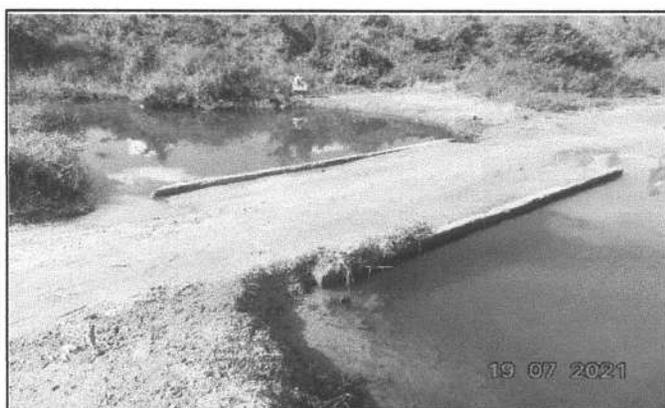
LOCAL DA CONSTRUÇÃO - BUEIRO
